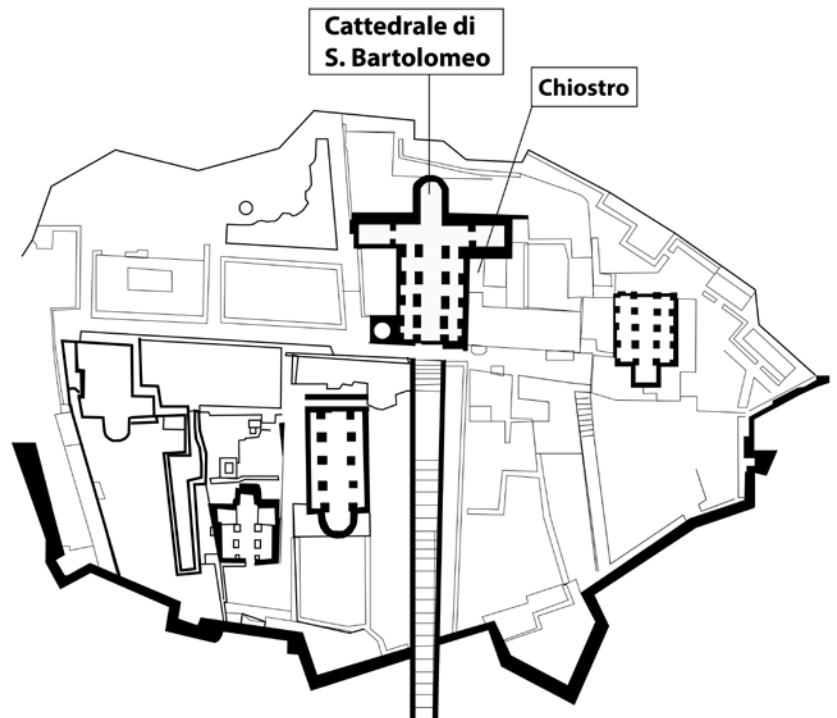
Lipari, Pianta del castello (pianta rielaborata da Rocco Burgio)
